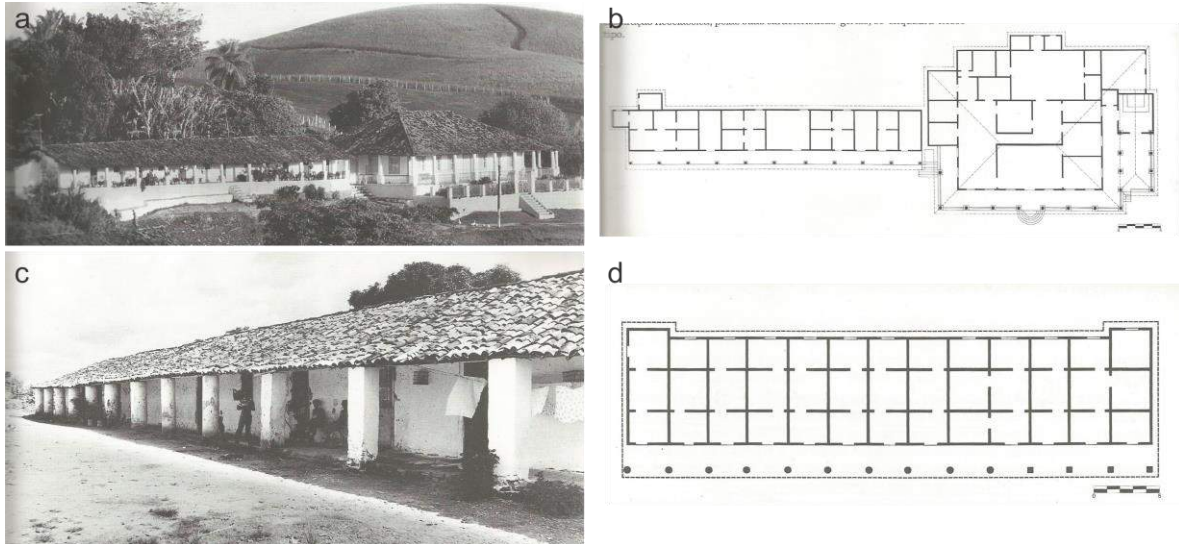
Senzalas de Engenhos Pernambucanos. a – vista da casa-grande e senzala do engenho Coimbras, no Cabo de Santo Agostinho; b – planta baixa do mesmo engenho; c – vista da senzala do engenho Jurissaca, no Cabo de Santo Agostinho; d – planta baixa do mesmo engenho.
